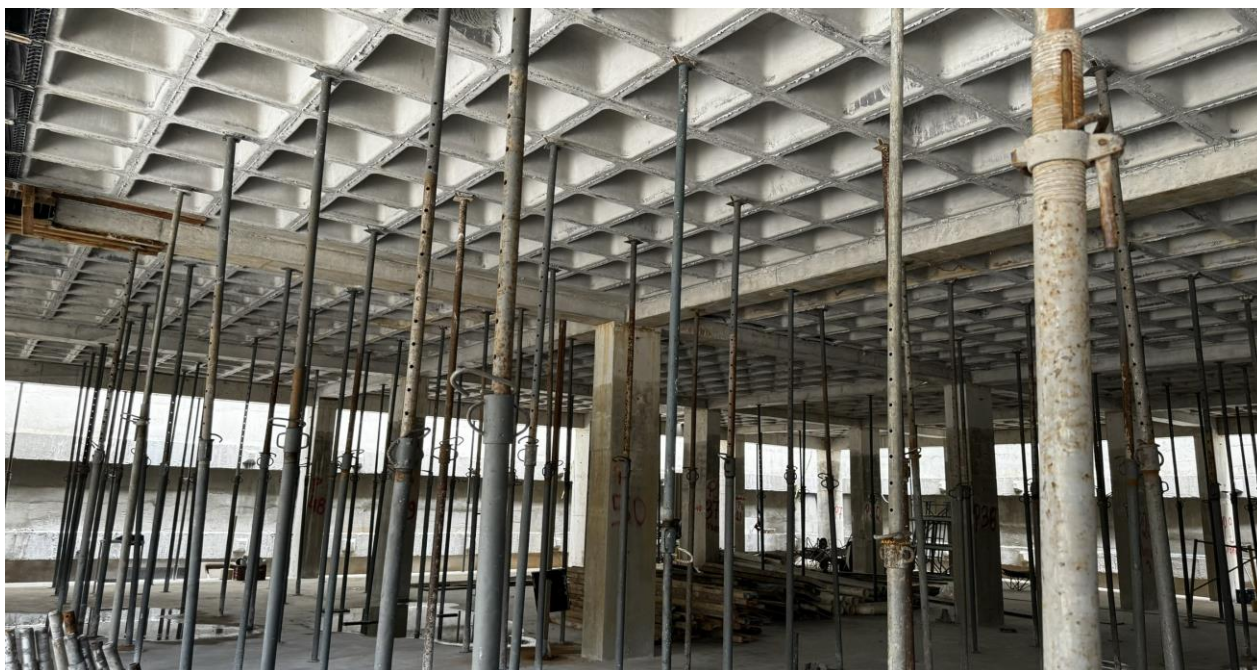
Retirada de parte do escoramento da laje de cobertura do segundo subsolo concretada.
